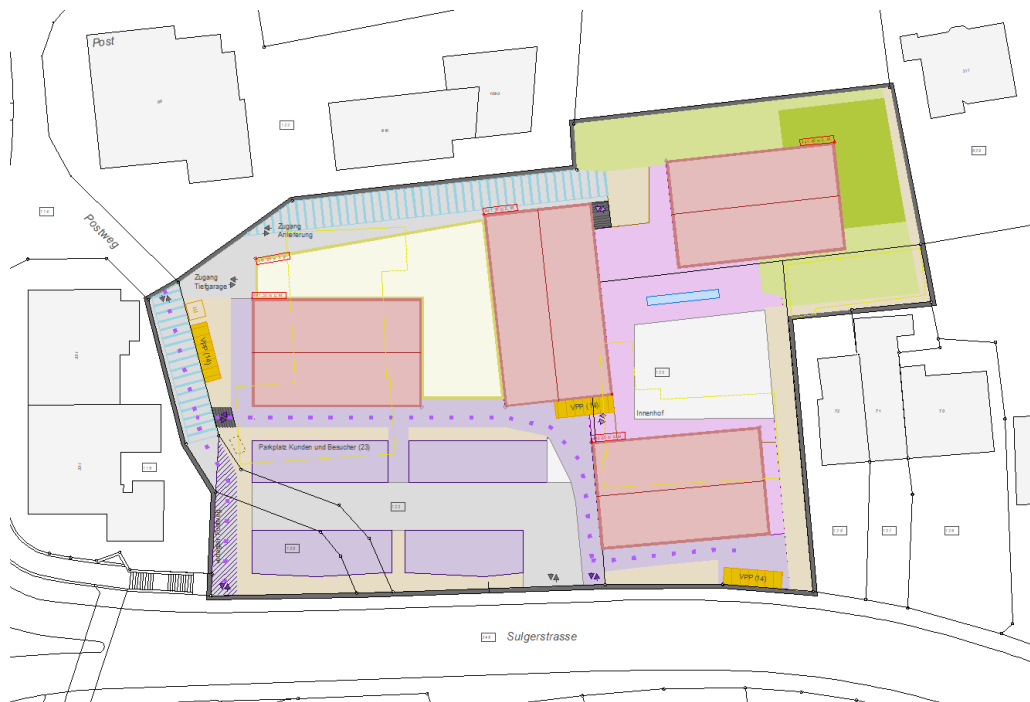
Ausschnitt aus dem Situationsplan 1:200. Erschliessungskonzept Fahrverkehr, Notzufahrt, Velozufahrt, Fusswege, Parkplatz Kunden / Besucher und Veloparkplätze. Plan: i+geo ag, Stand Oktober 2022.
